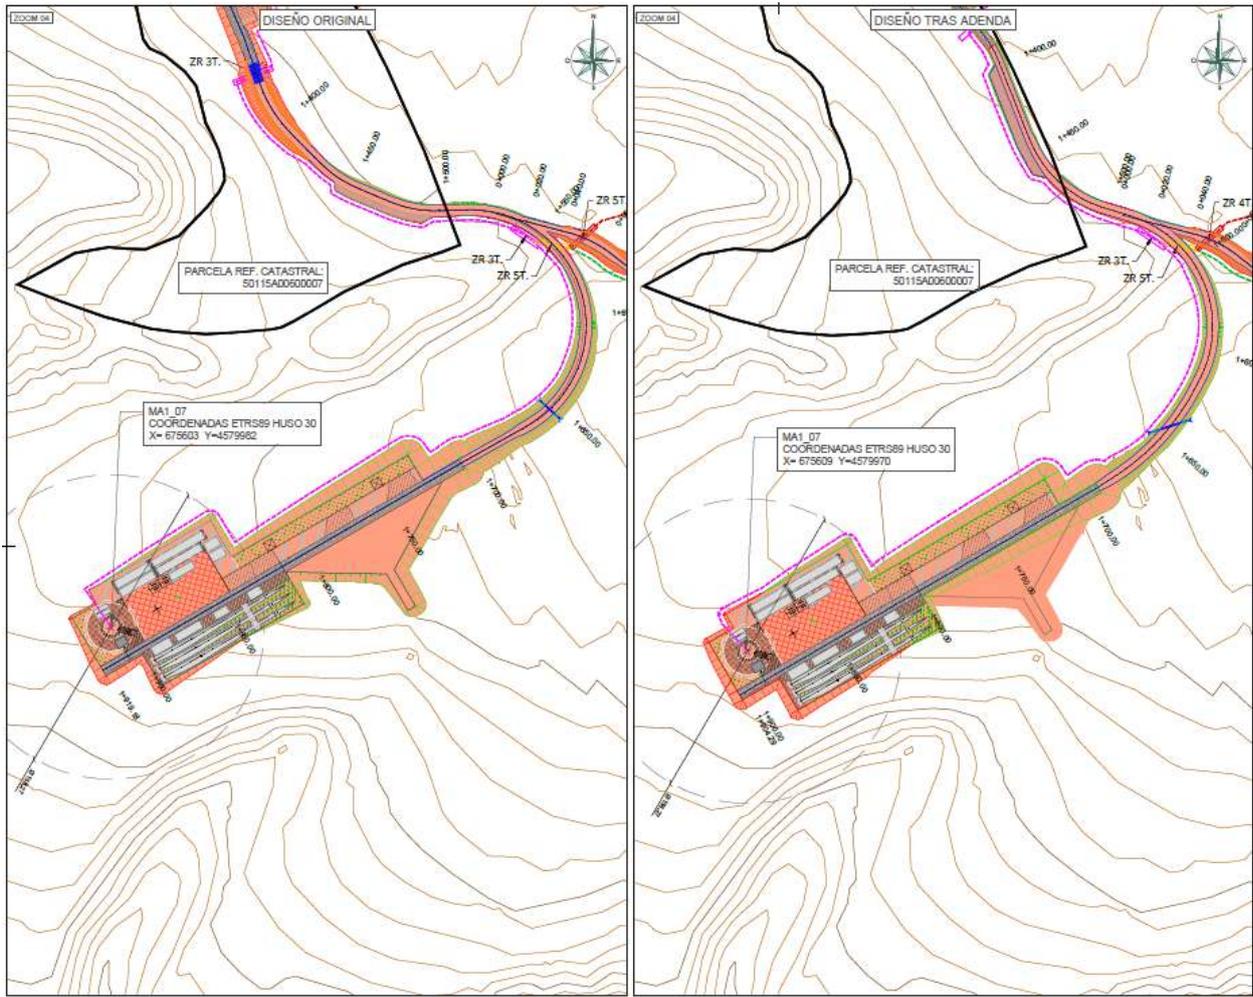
Desvío zanja por modificado vial MAR1\_02
